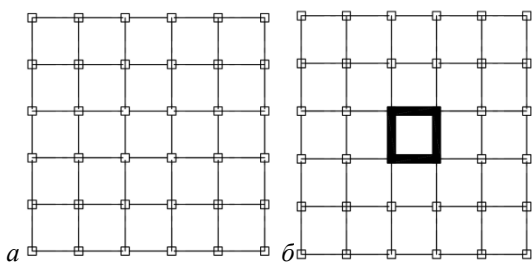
Схеми планувань багатопверхових будівель гібридної конструкції: а) жорстке з'єднання вузлів; б) шарнірне з'єднання вузлів та ядро жорсткості
